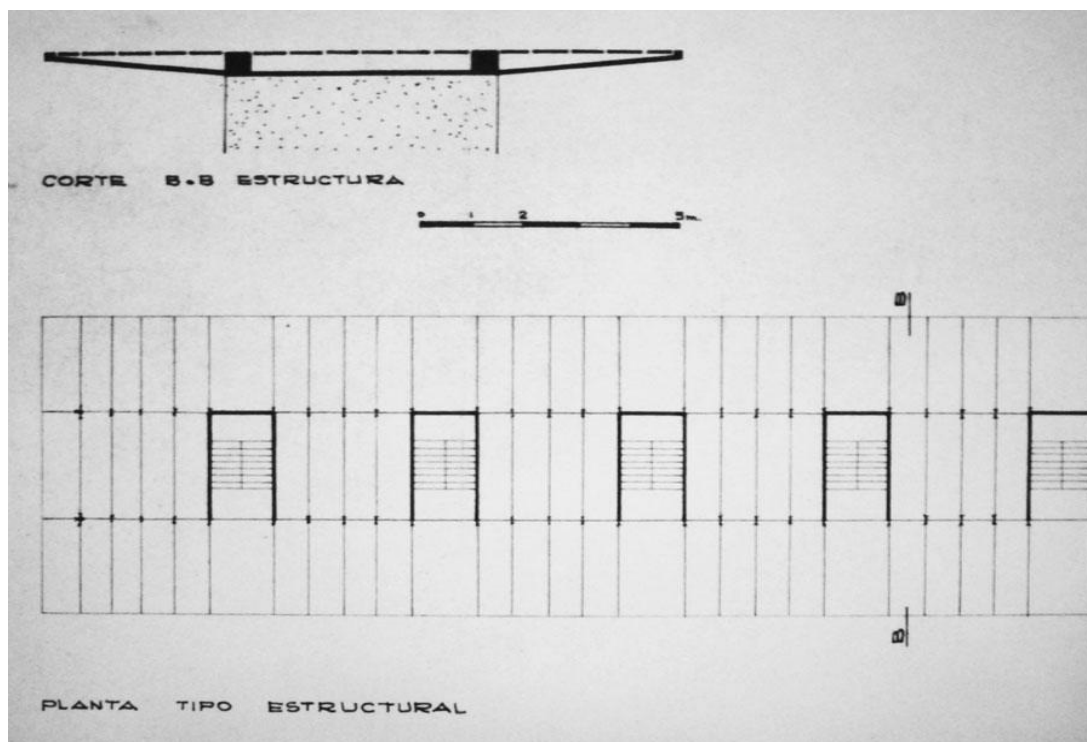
Sector de planta tipo estructural del edificio L'Hirondelle. Fuente: Centro de Documentación del Instituto de Historia, FADU, Udelar.
